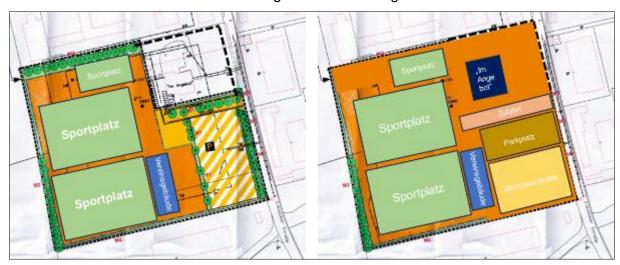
Vergleich Bestandsplan mit dem neuen Bebauungsplan (links Altplan, mit Sport- und Gebäudeflächen; rechts aktuelles Planvorhaben mit Mehrzweckhalle/Parkplatz, Fortbestand Sportplatz)
